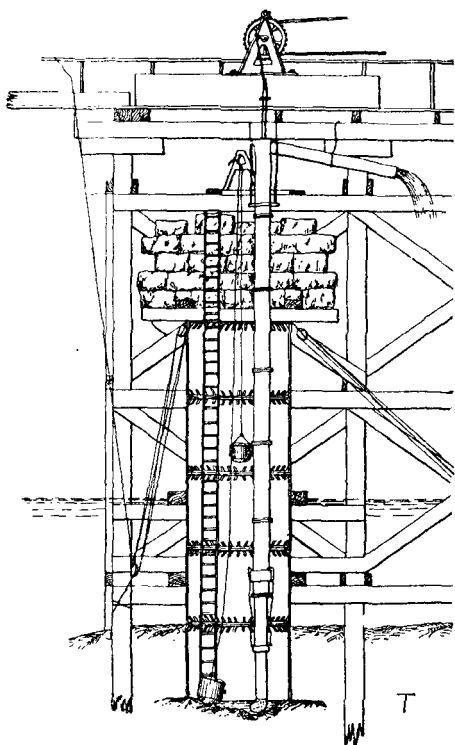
przedstawia wzór urządzenia przy zapuszczaniu studzien żela-
